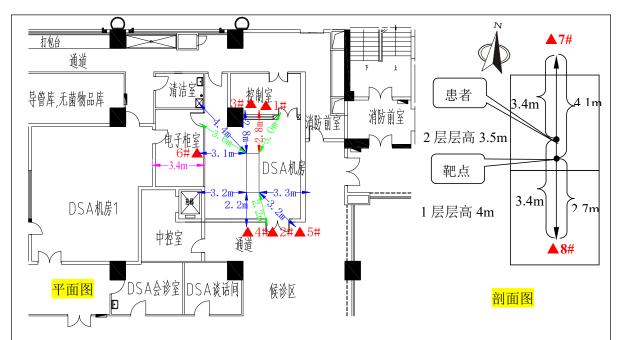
DSA 机房外关注点示意图 (平面图及剖面图)
